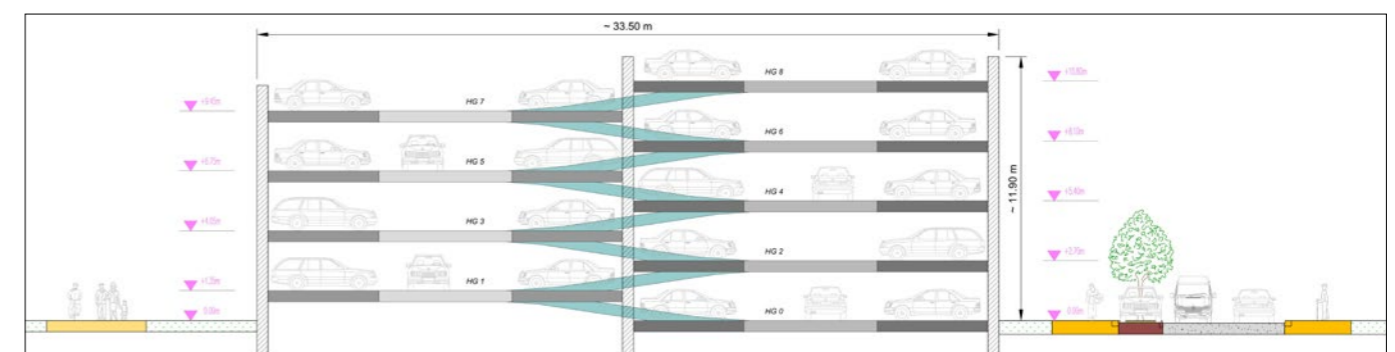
Schnittskizze einer reinen Bewohnersammelgarage
